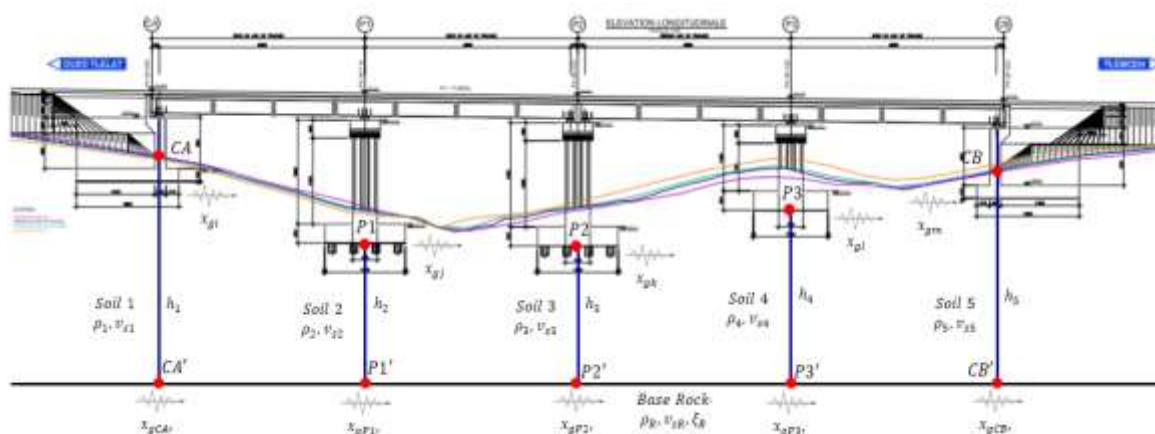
58. Vue longitudinale du pont et du sol de fondation.
